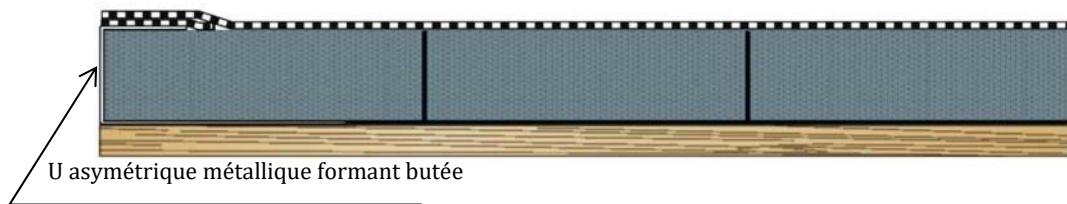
Coupe de principe sur rive sans acrotère, sur élément porteur bois - panneaux à base de bois
